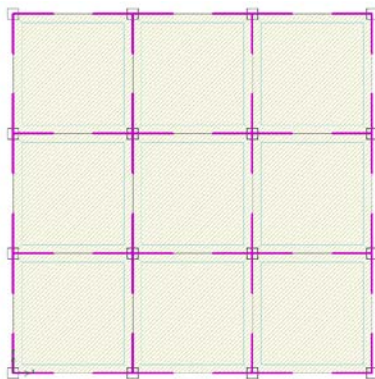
План типового этажа здания, выполненного в ПК МОНОМАХ.
